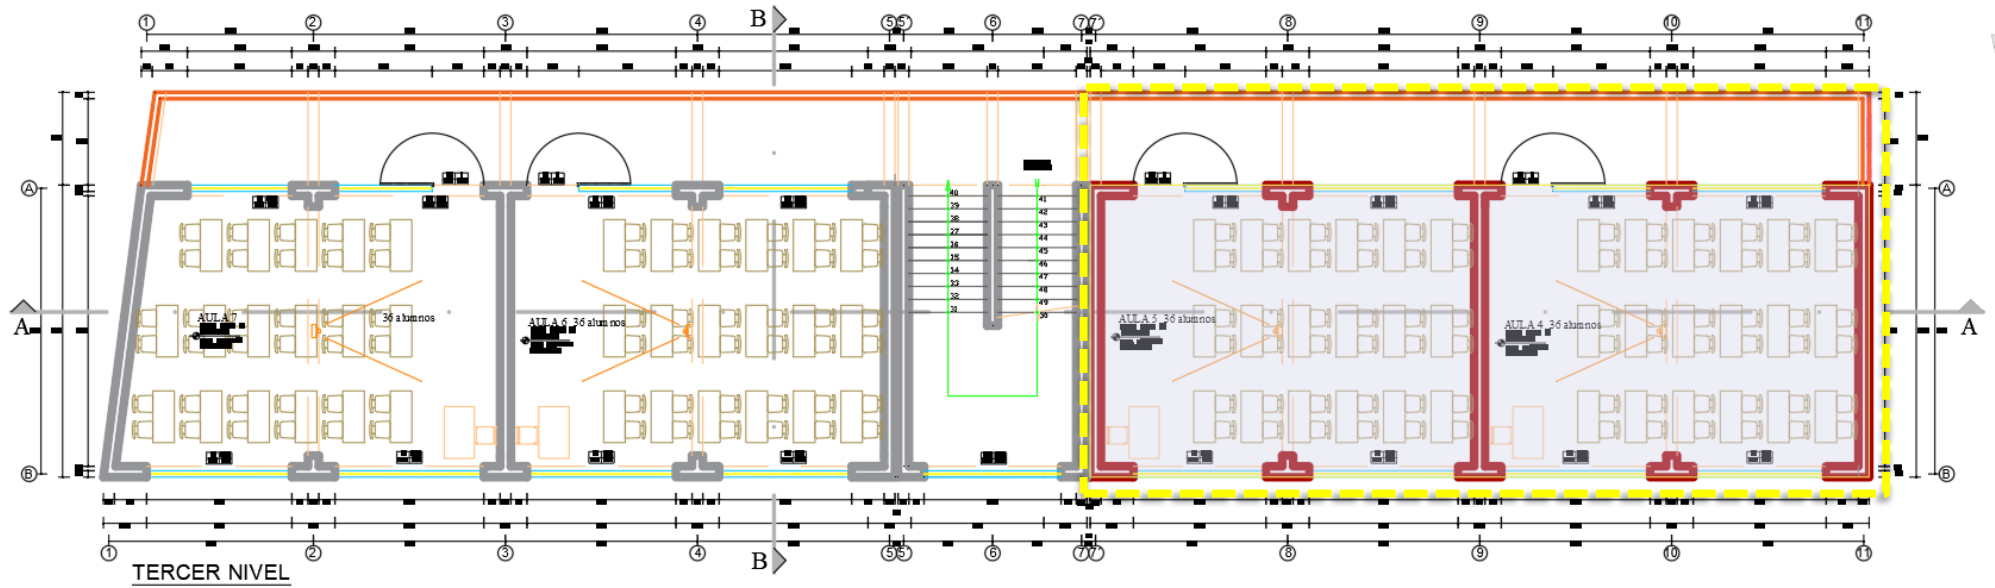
Vista en planta, piso 3, bloque 2 del pabellón A - I.E. N°40092
